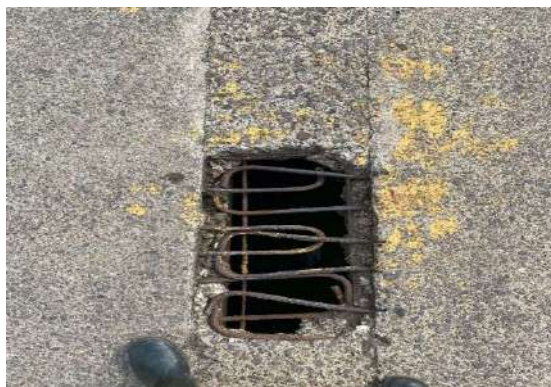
Baranda de concreto con acero de refuerzo expuesto y reducción de la sección.
